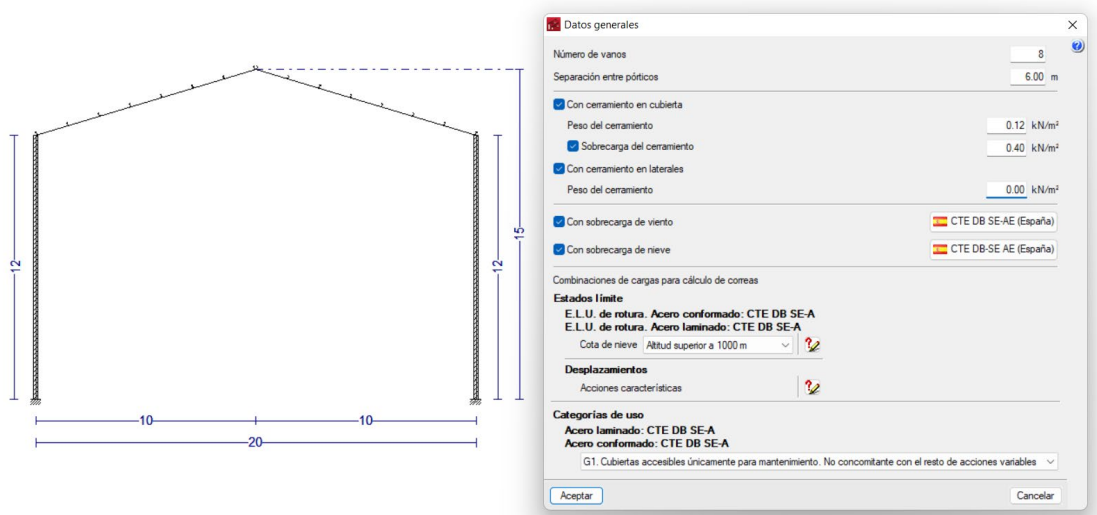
Nuevo pórtico planteado y detalles de configuración.
